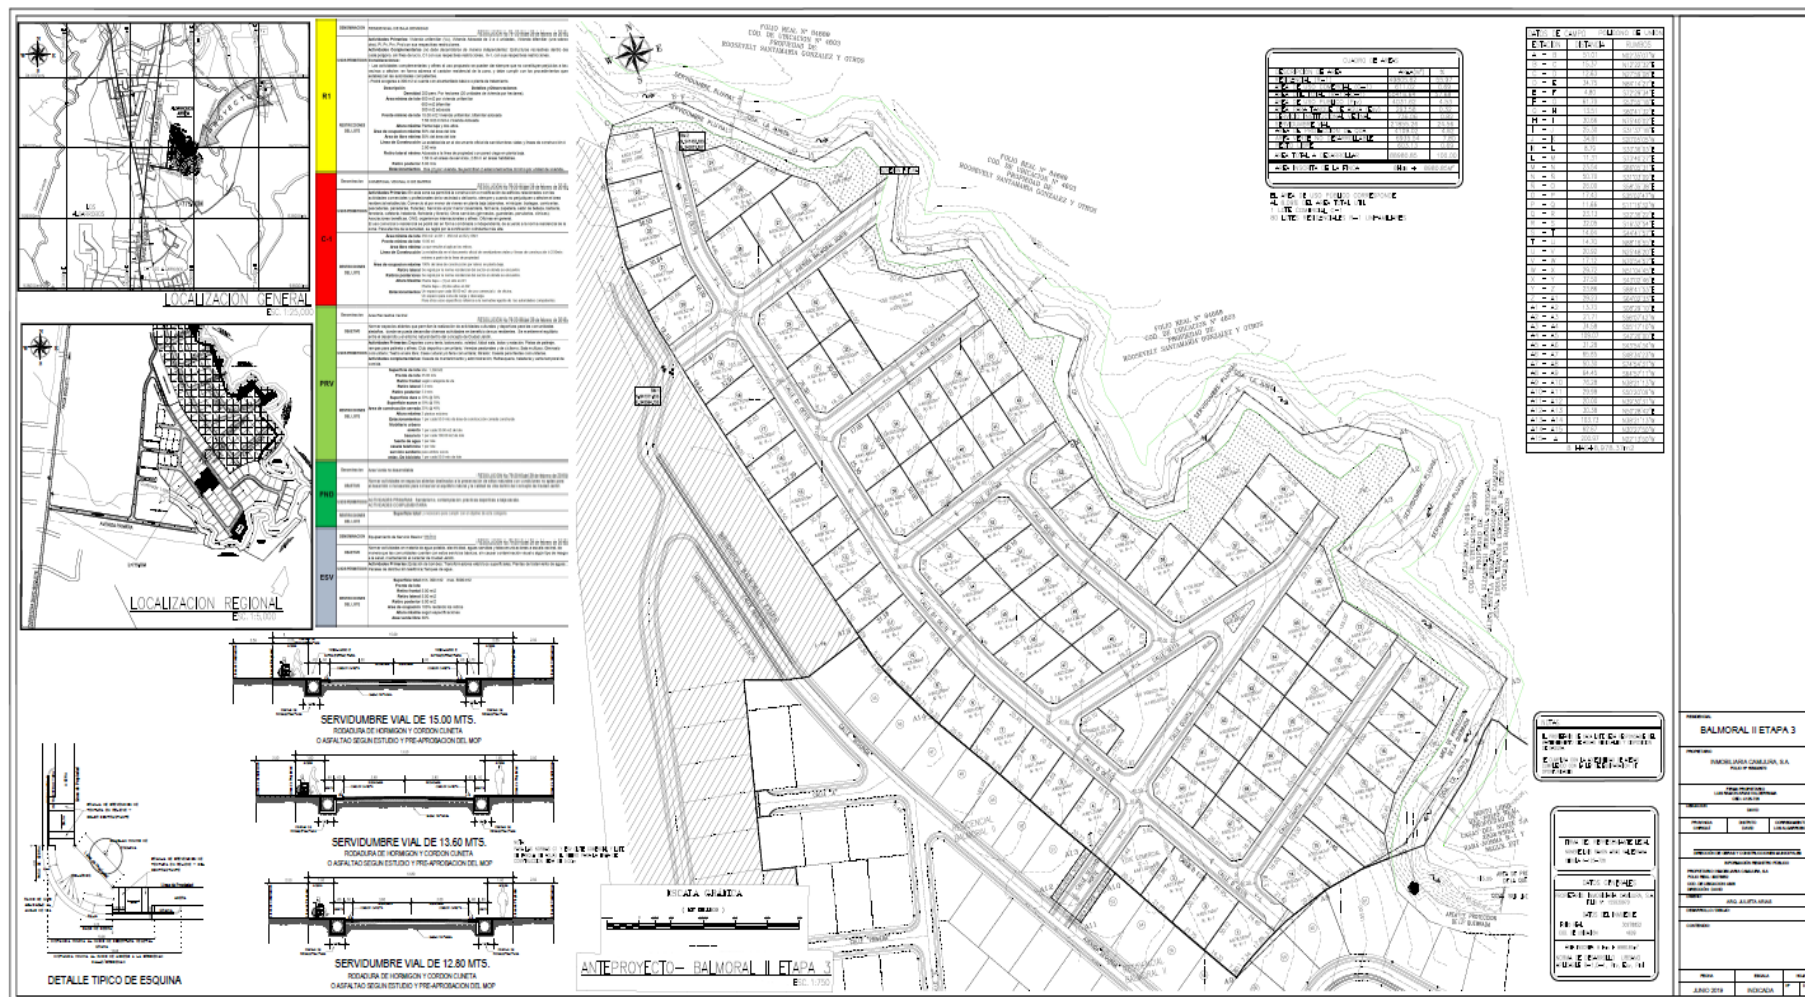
Planta de lotificación “Residencial Balmoral II Etapa 3”. Fuente: Planos de Anteproyecto
